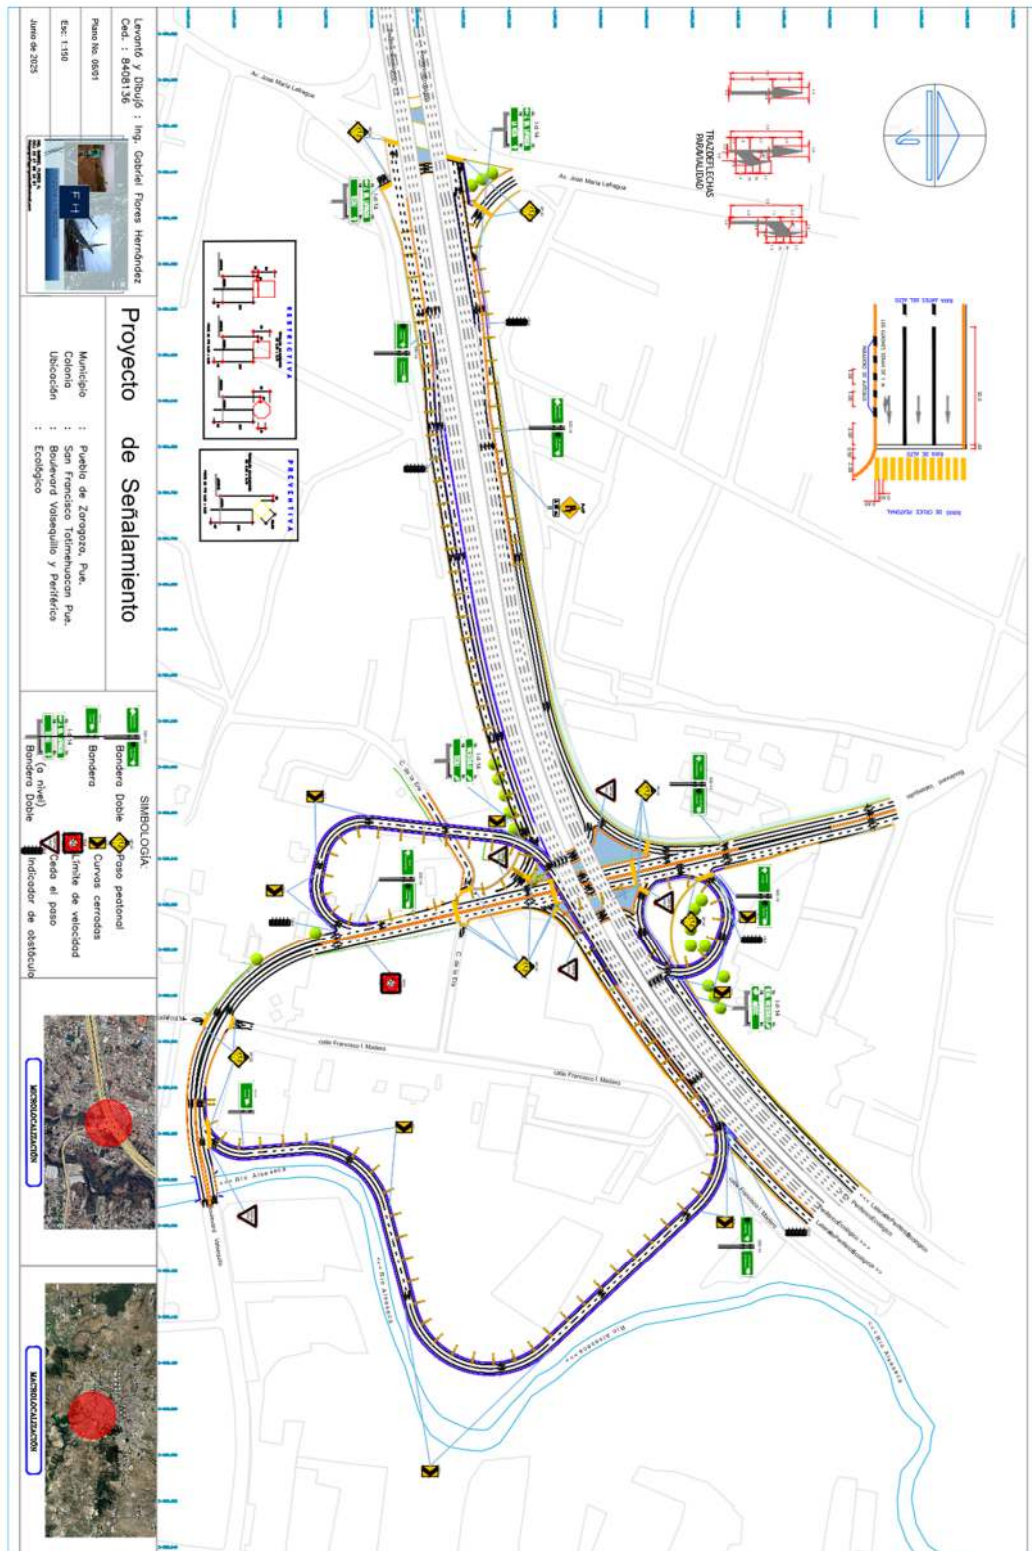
Planta de señalamiento horizontal y vertical. Fuente: (Propia)
